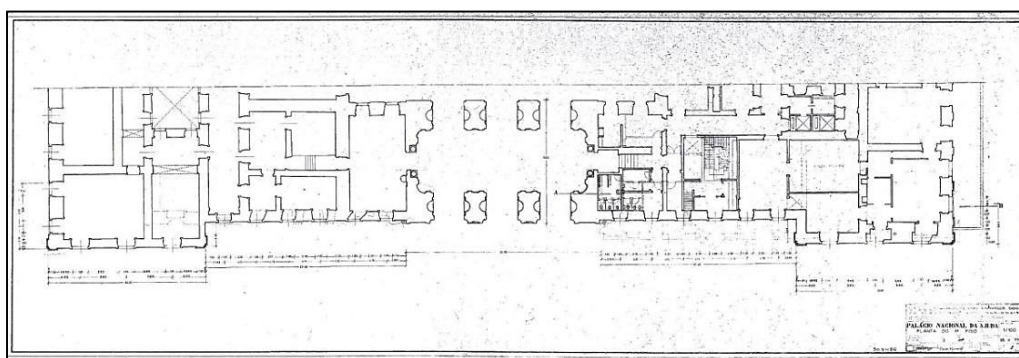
Planta do piso térreo da Ala Poente. Projeto de João Seabra, 1977.
